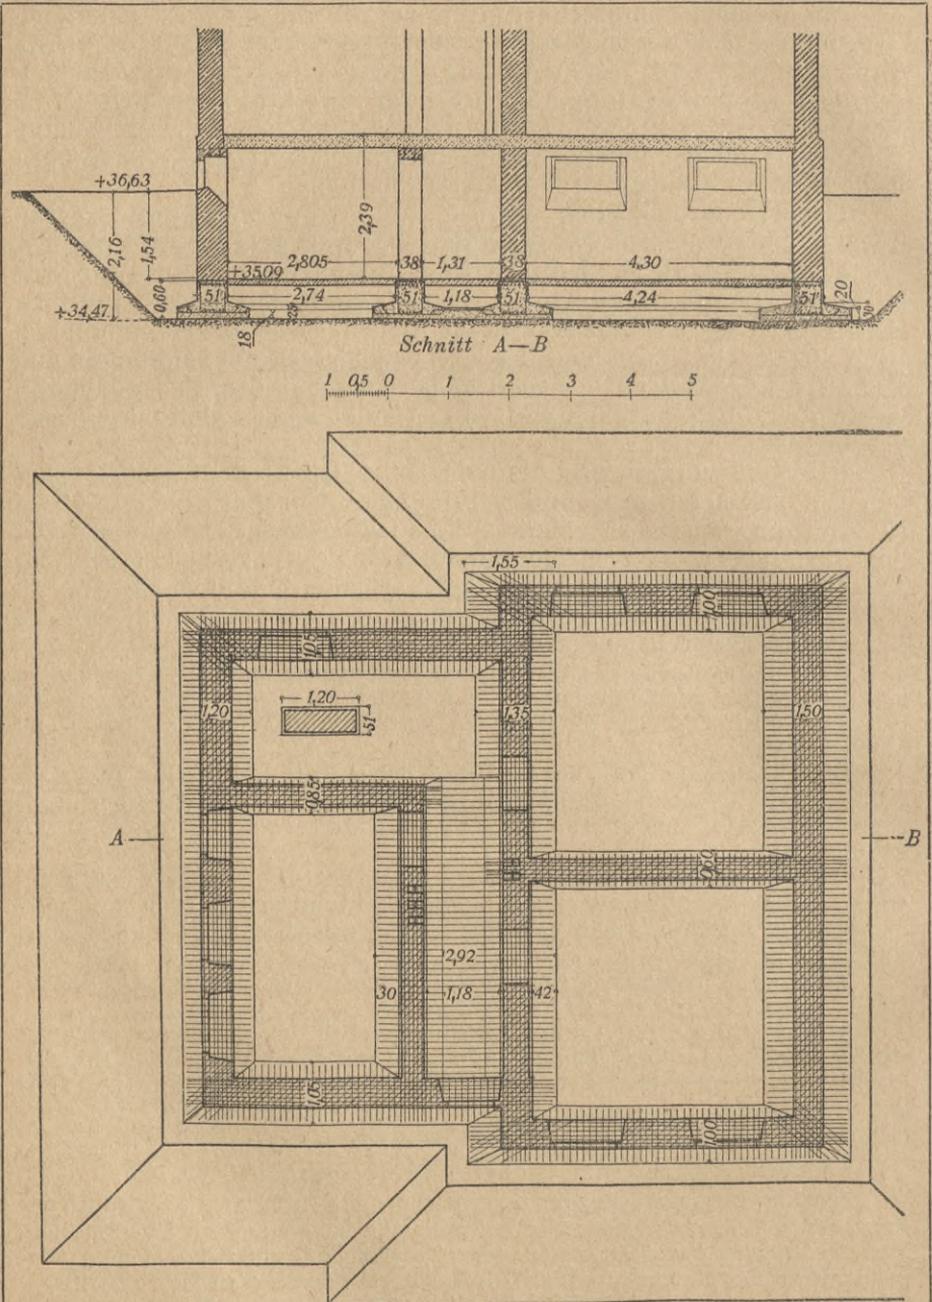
Gründung eines freistehenden Wohnhauses (siehe Anhang) auf einen Eisenbetonplattenrost. [Berechnungsbeispiel 2.]
